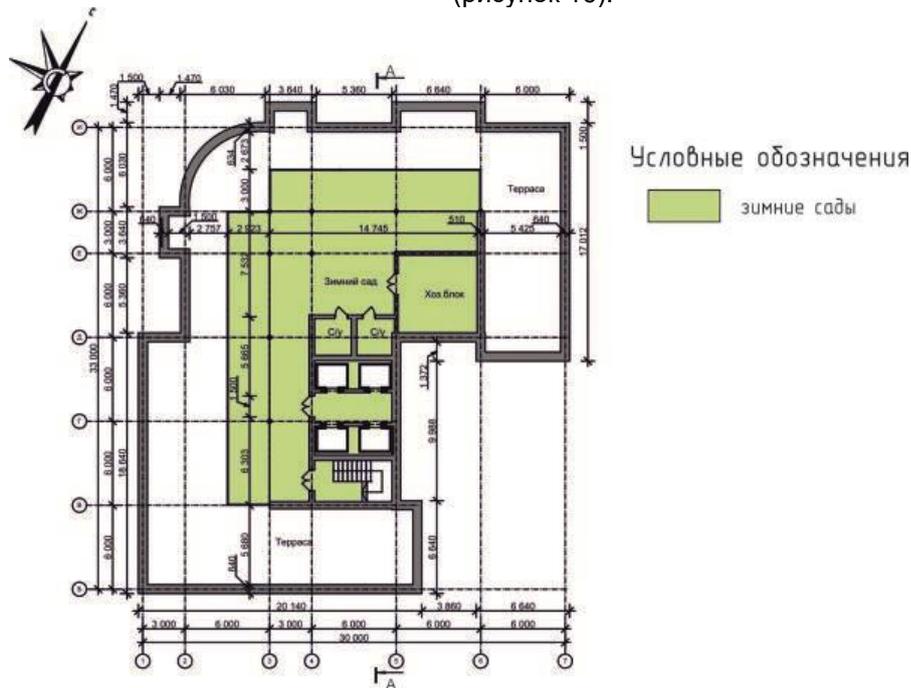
План зимнего сада на крыше жилого комплекса
